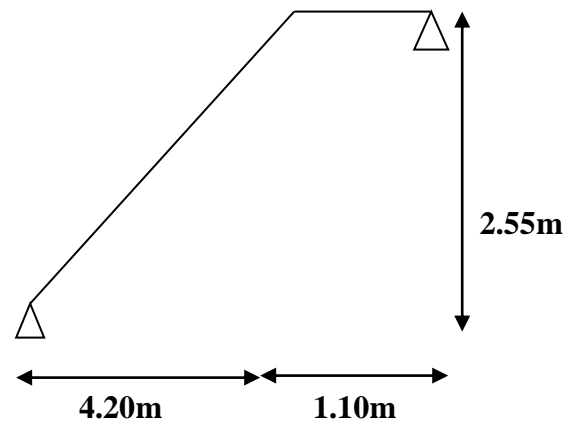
Schéma du 1^{er} type d'escalier RDC
